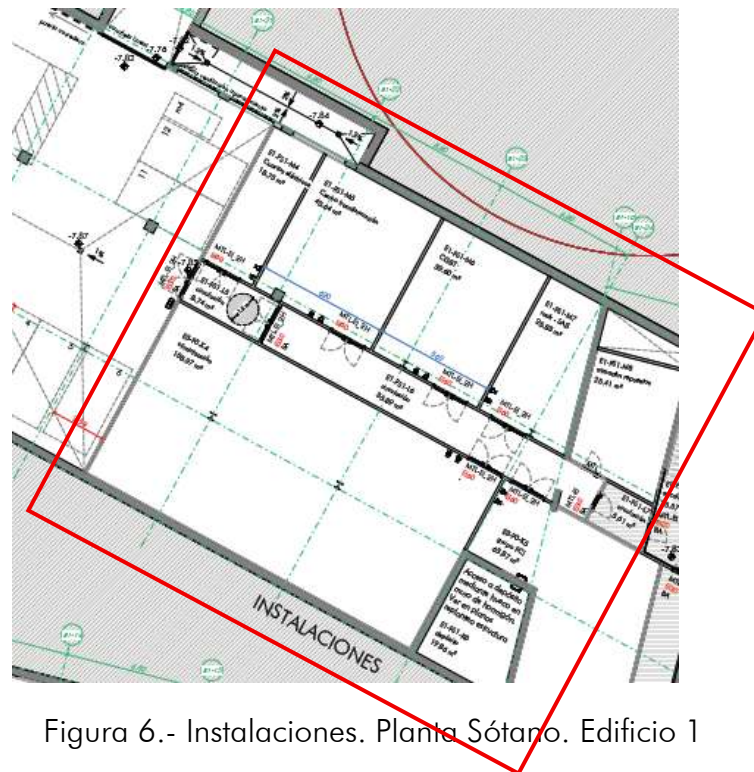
Instalaciones. Planta Sótano. Edificio 1
